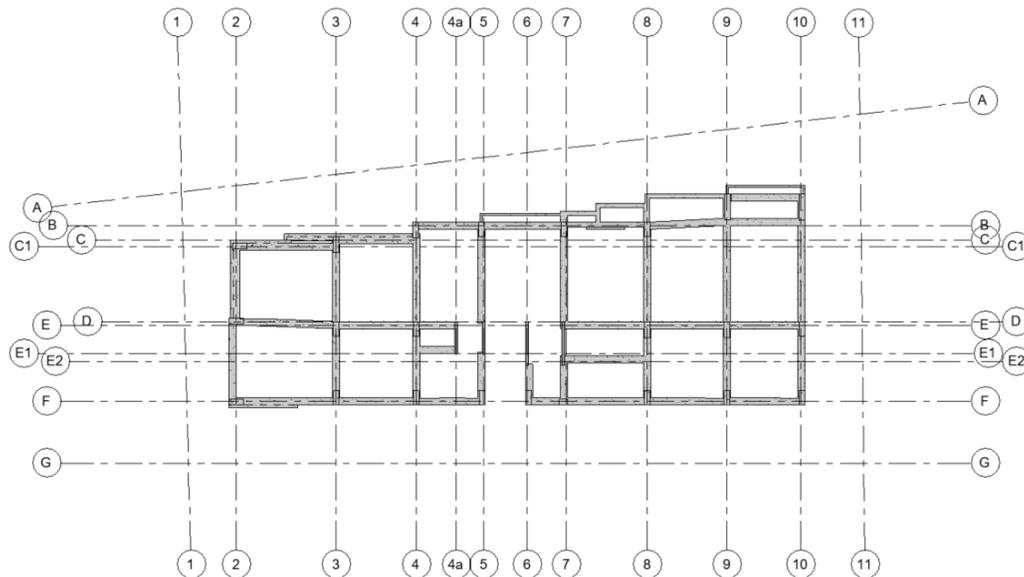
Modelado de vigas, vista en planta, piso 5 – 11.
